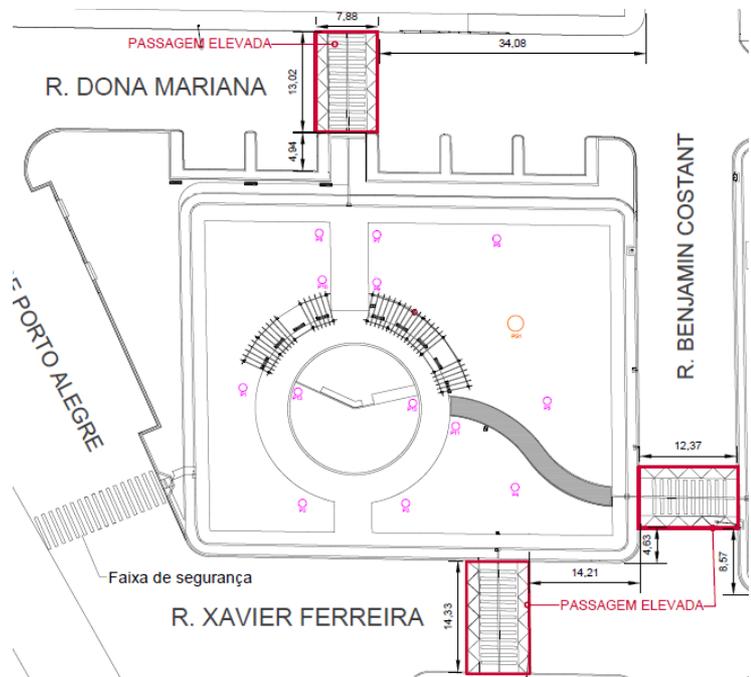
Plantas de localização dos postes e detalhamento das passagens elevadas e faixa de segurança
